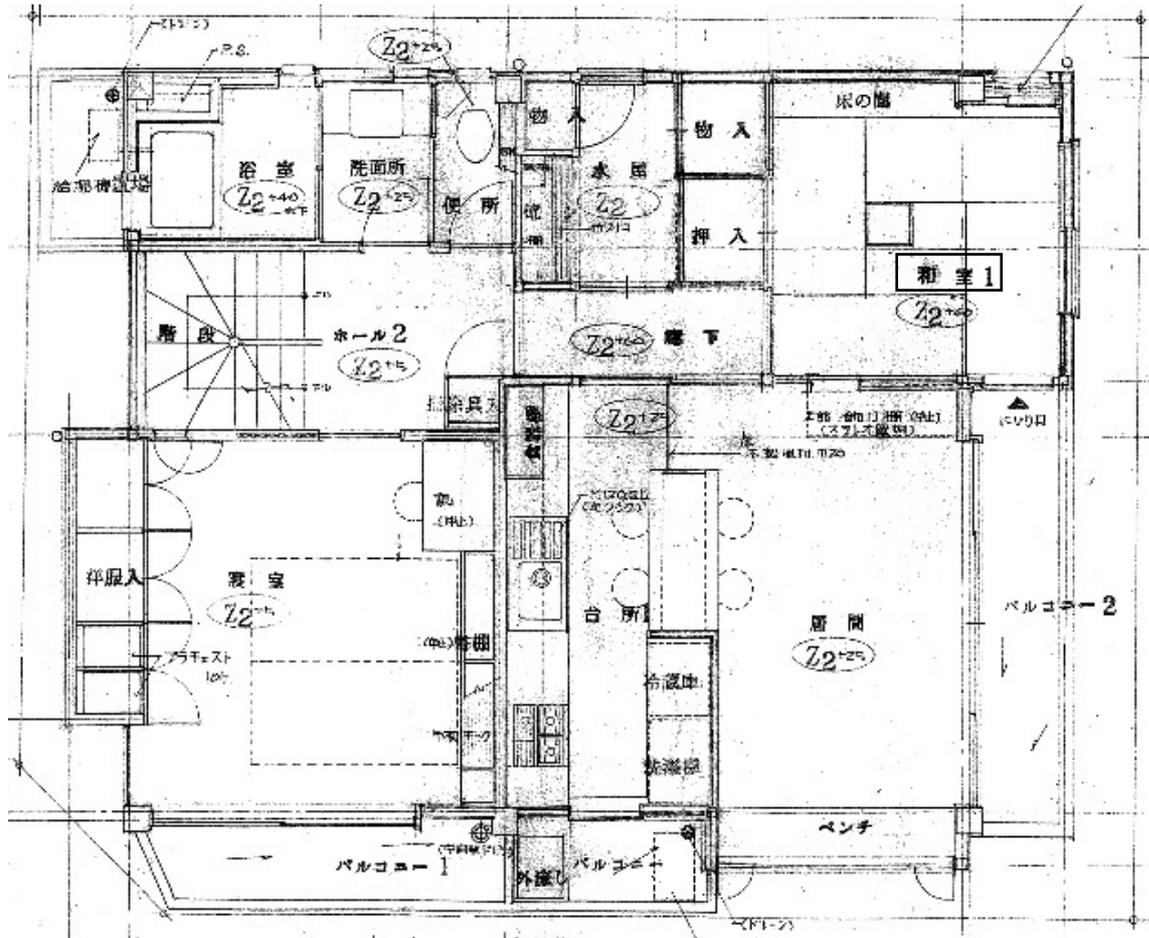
「斉藤邸 (Kさんの家/斎藤邸)」2階平面図
